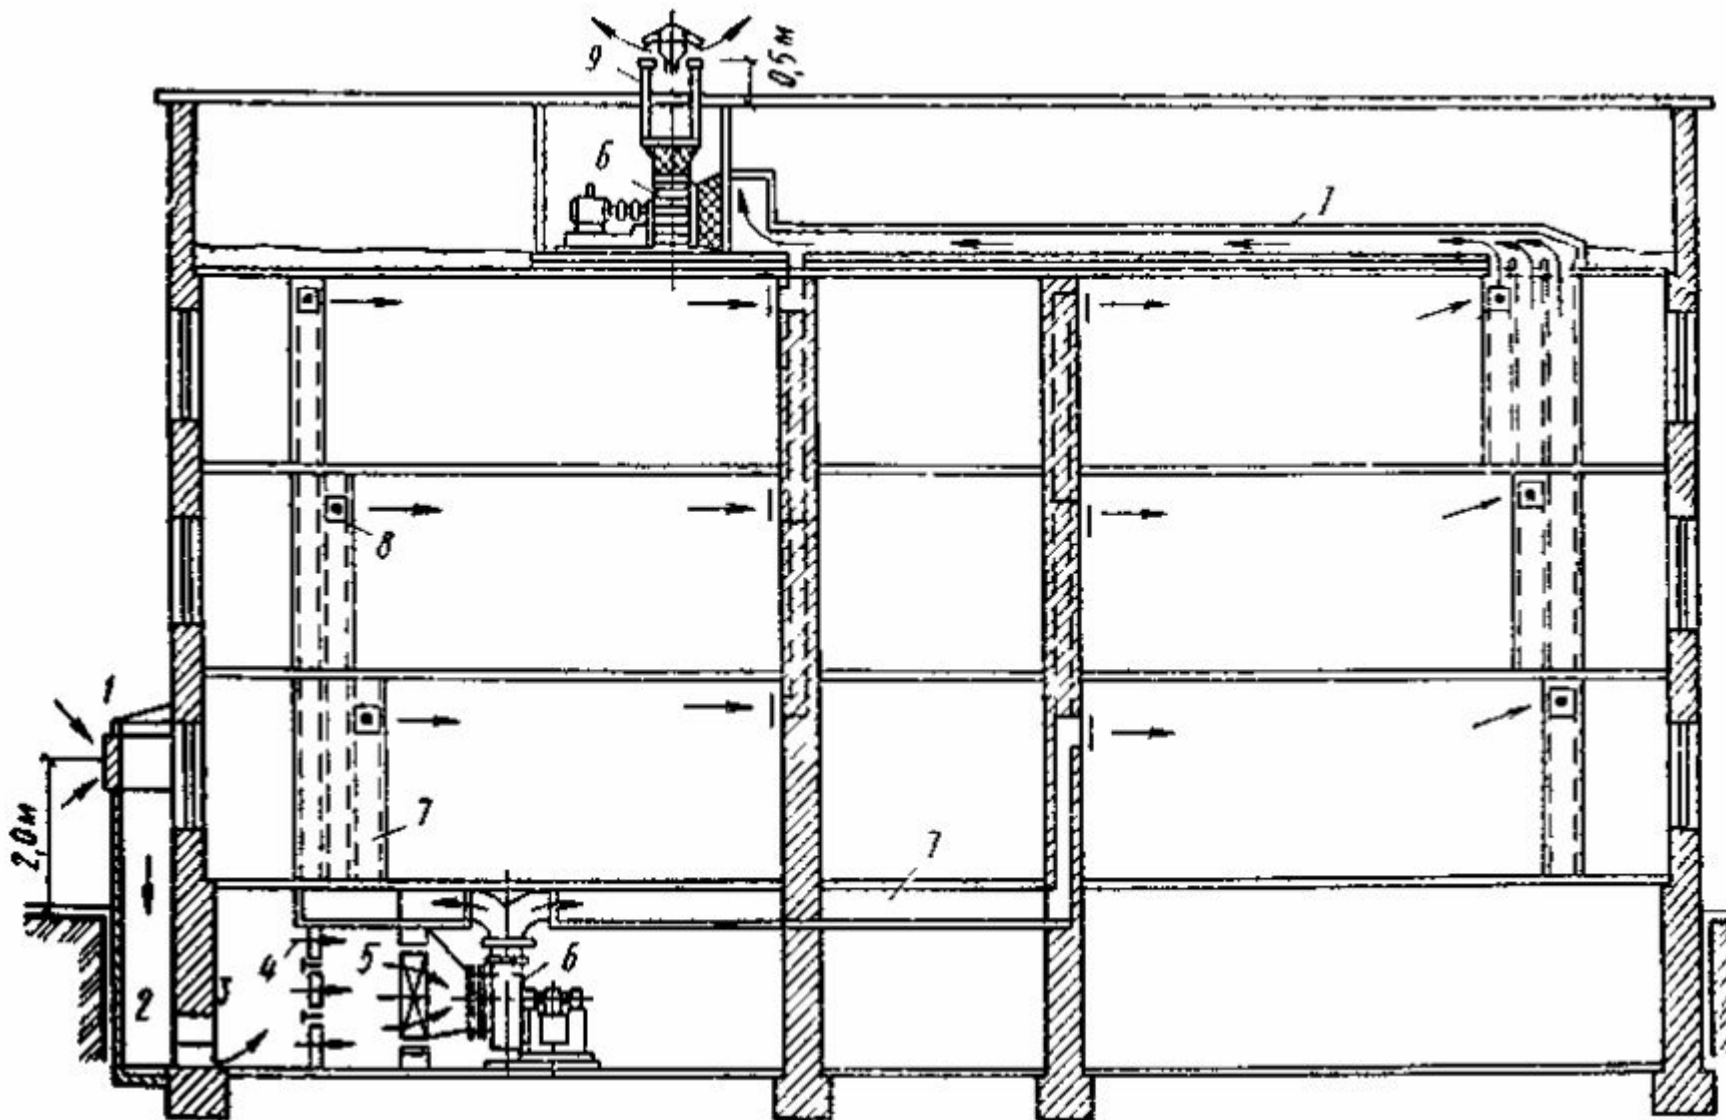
Схема механической приточно-вытяжной вентиляции: 1,8 – жалюзийная решетка, 2 – воздухозаборное устройство, 3 – утепленный клапан, 4 – фильтр, 5 – калориферы, 6 – вентилятор, 7 – каналы и воздуховоды, 9 – вытяжная шахта
